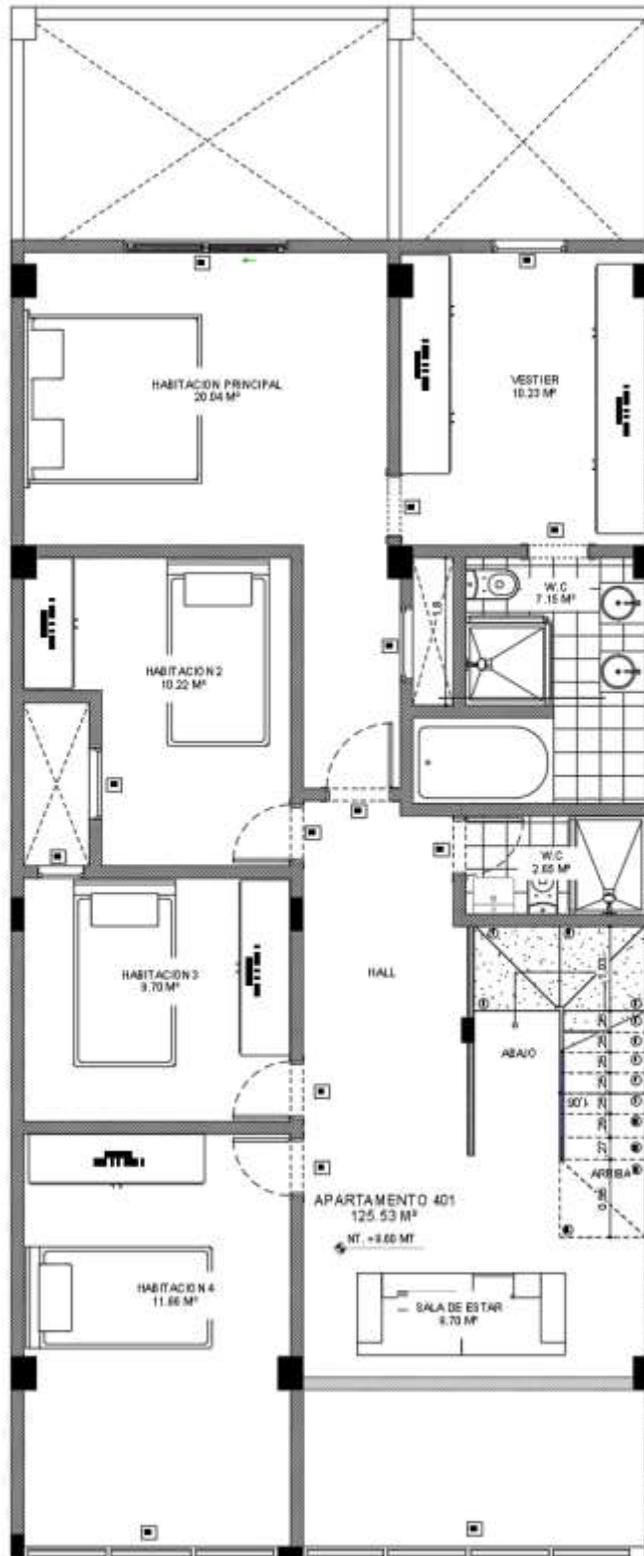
Plano arquitectónico Nivel 5 - Adoptado de: Reconstrucciones.
